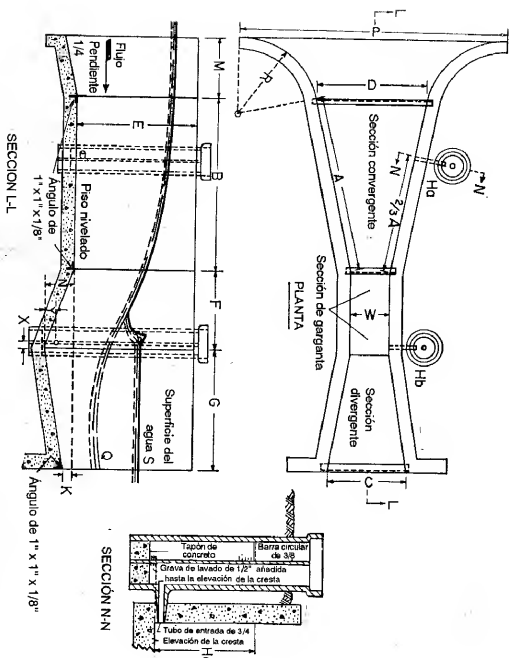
Planta, elevación y dimensiones de una canaleta Parshall. (U. S. Soil Conservation Service [26]). Planta y elevación de una canaleta Parshall de medición en concreto, que muestra las siguientes dimensiones demarcadas:
